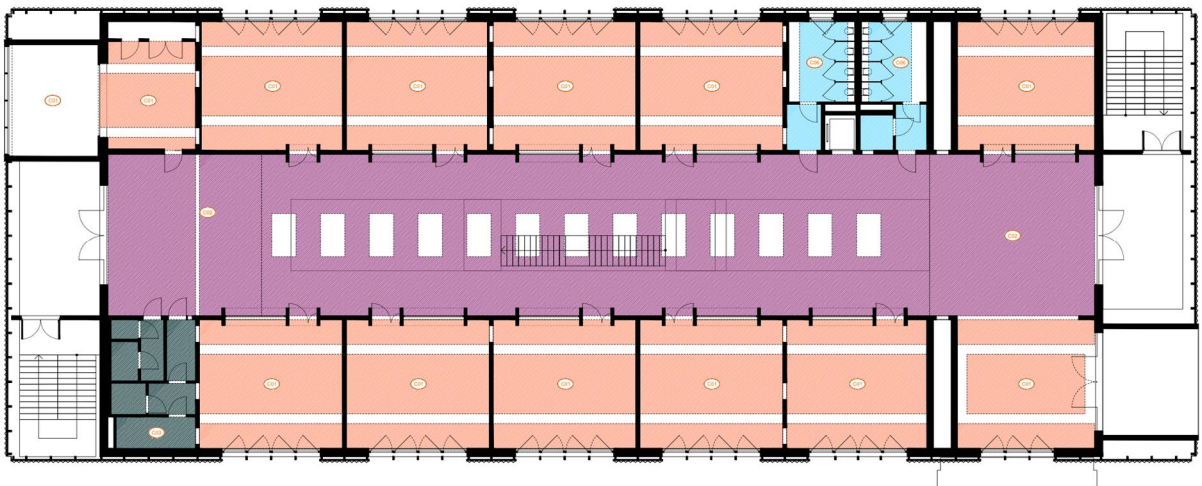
Pianta piano secondo con indicazione dei trattamenti acustici delle aule
